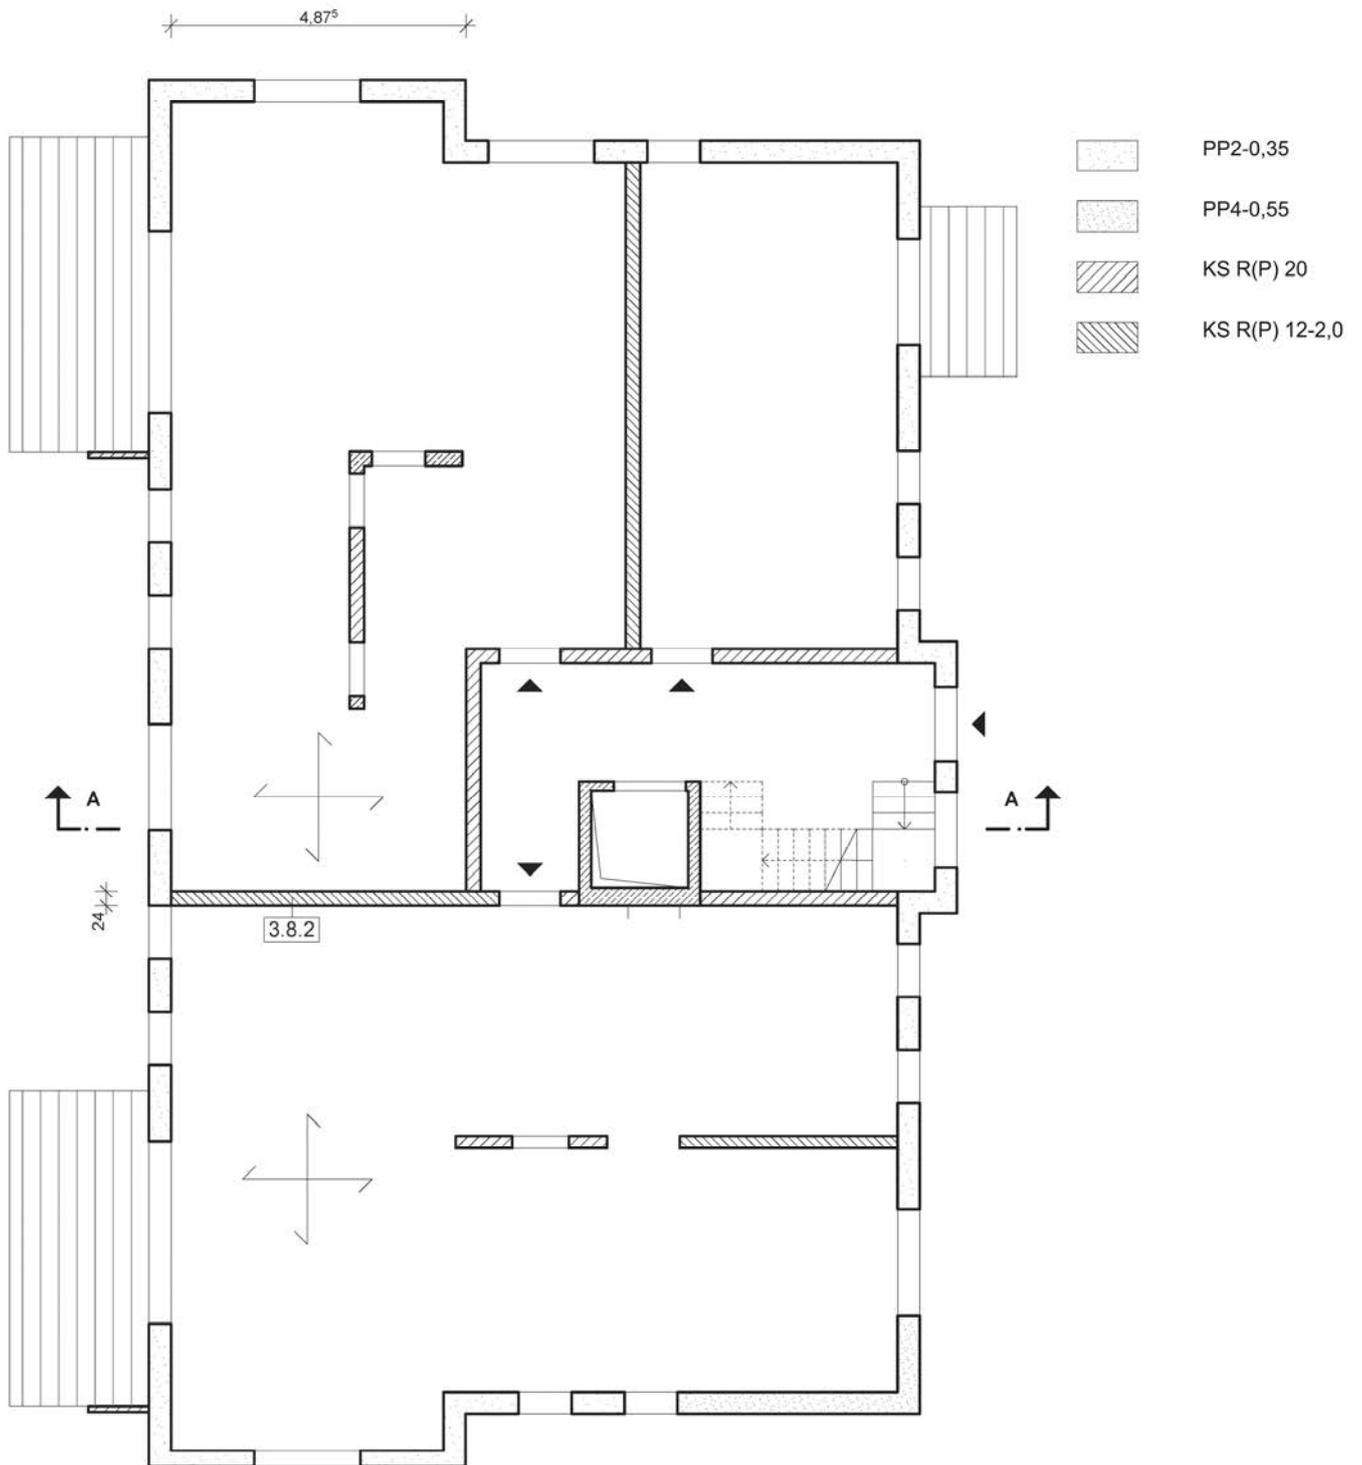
Mehrfamilienhaus in Dresden, Grundriss Erdgeschoss
